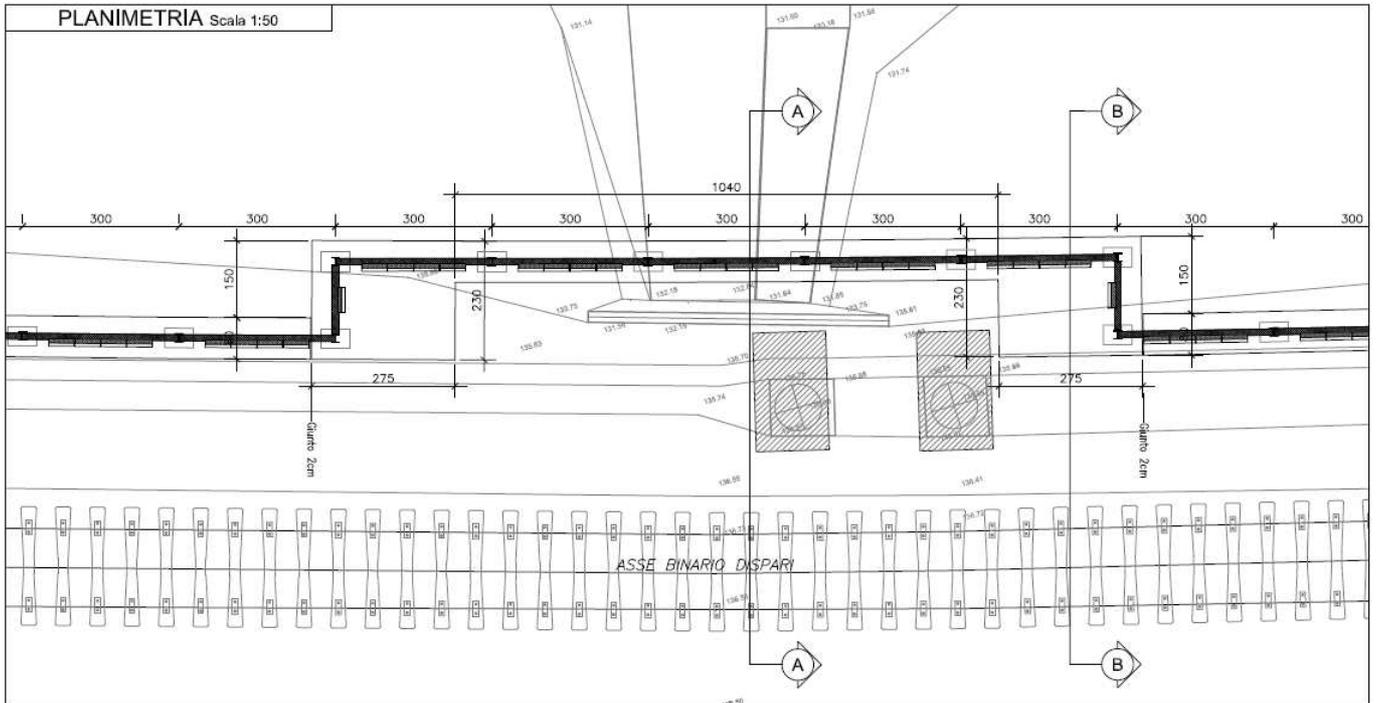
stralcio planimetrico scavalco L=10.40m
